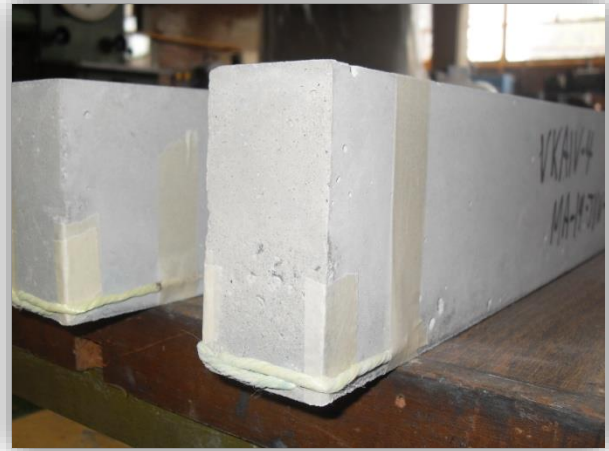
Tramos sobrantes de los refuerzos de Aramida posteriormente adheridos con resina epóxica a la superficie de concreto de la viga
